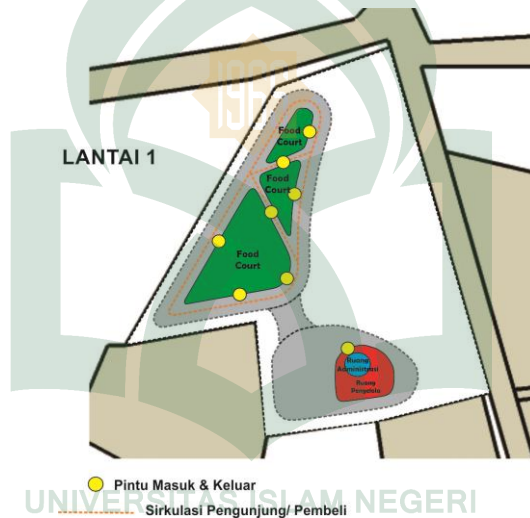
Sketsa Denah Lantai 1 pada Bentuk Alternatif 1
